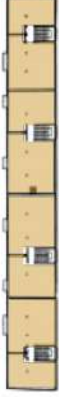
Fragmento da Planta do 1º Pav. E: 1/200
